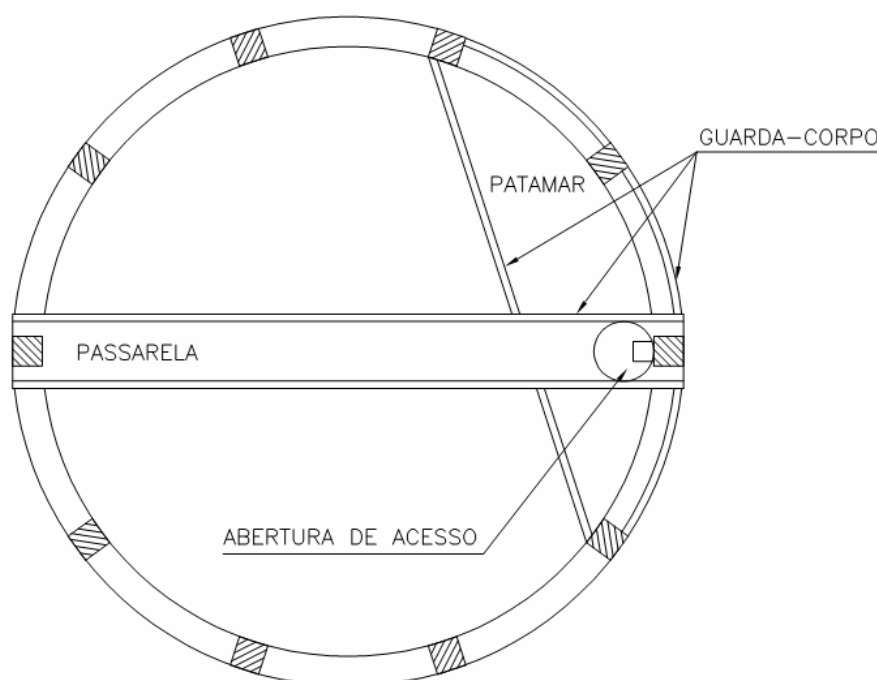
vista em corte da estrutura de apoio e acesso, conforme projeto hidráulico (trabalho não publicado<sup>4</sup>)
